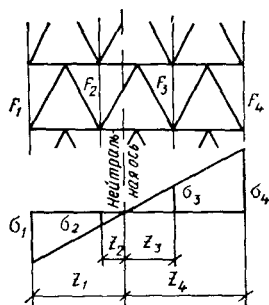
Напряжения в колоннах от изгибающего момента в связевой ферме при условии сохранения плоских сечений фермы
